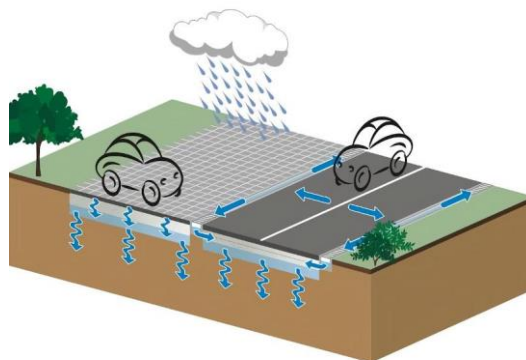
Structures réservoirs infiltrantes : à gauche parking poreux à droite chaussée réservoir à injection d'eau latérale
